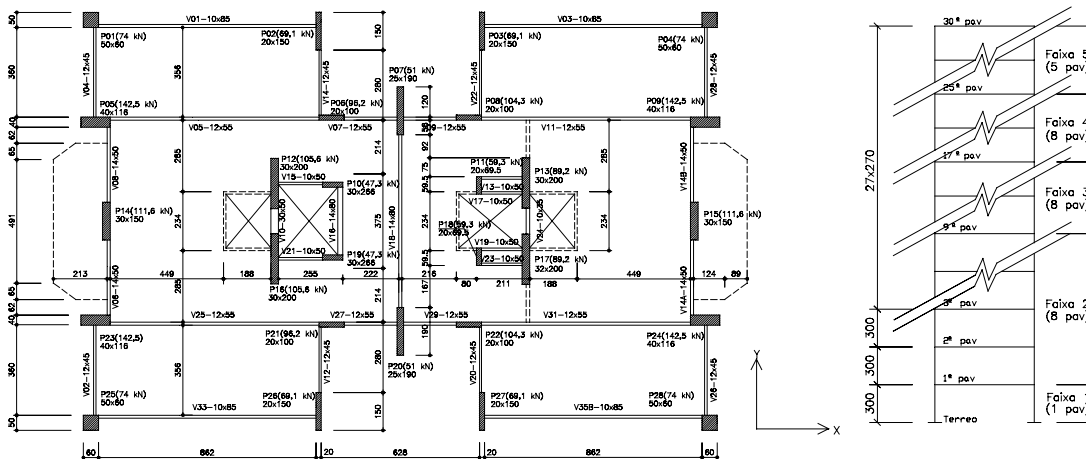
Edifício TORRE PERDIZES (geometria e carga nos pilares)
